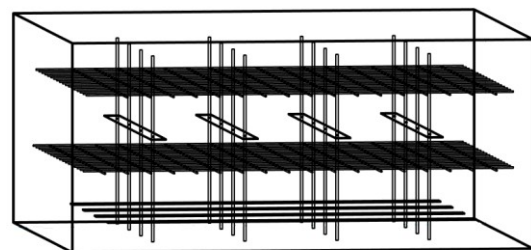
HET VOORAANZICHT VAN DE WAPENING IN DE FUNDERING
